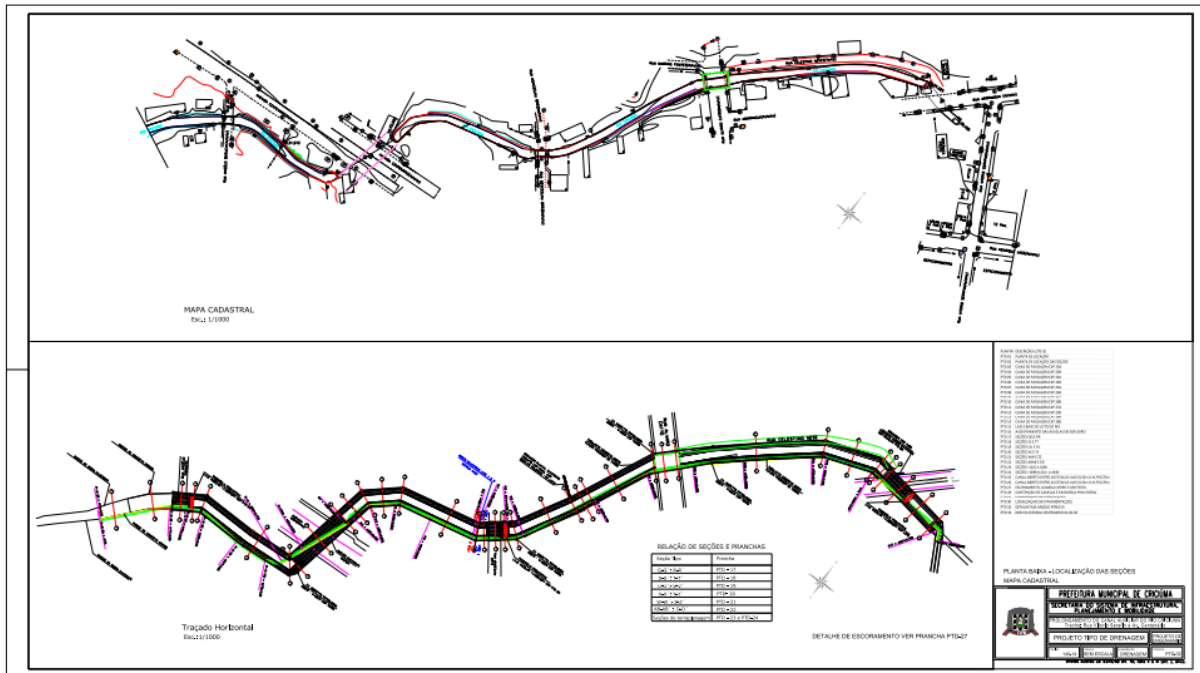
Planta baixa localização das seções. (Fonte: PMC)
